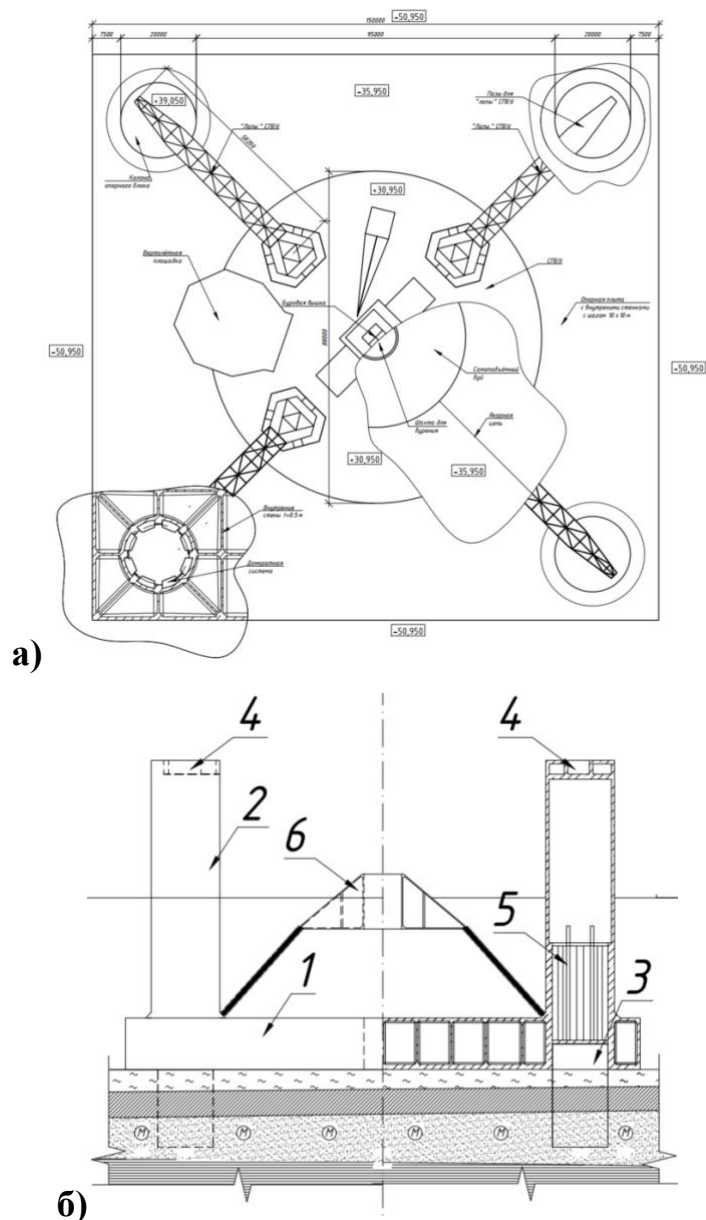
Конструктивная схема ГКФ: а) план; и б) совмещённый фасад и разрез по колонне: 1 – опорная плита; 2 – колонна; 3 – вакуумный кессон; 4 – стыковочный паз; 5 – домкратная система; 6 – самоподъёмный буй.
